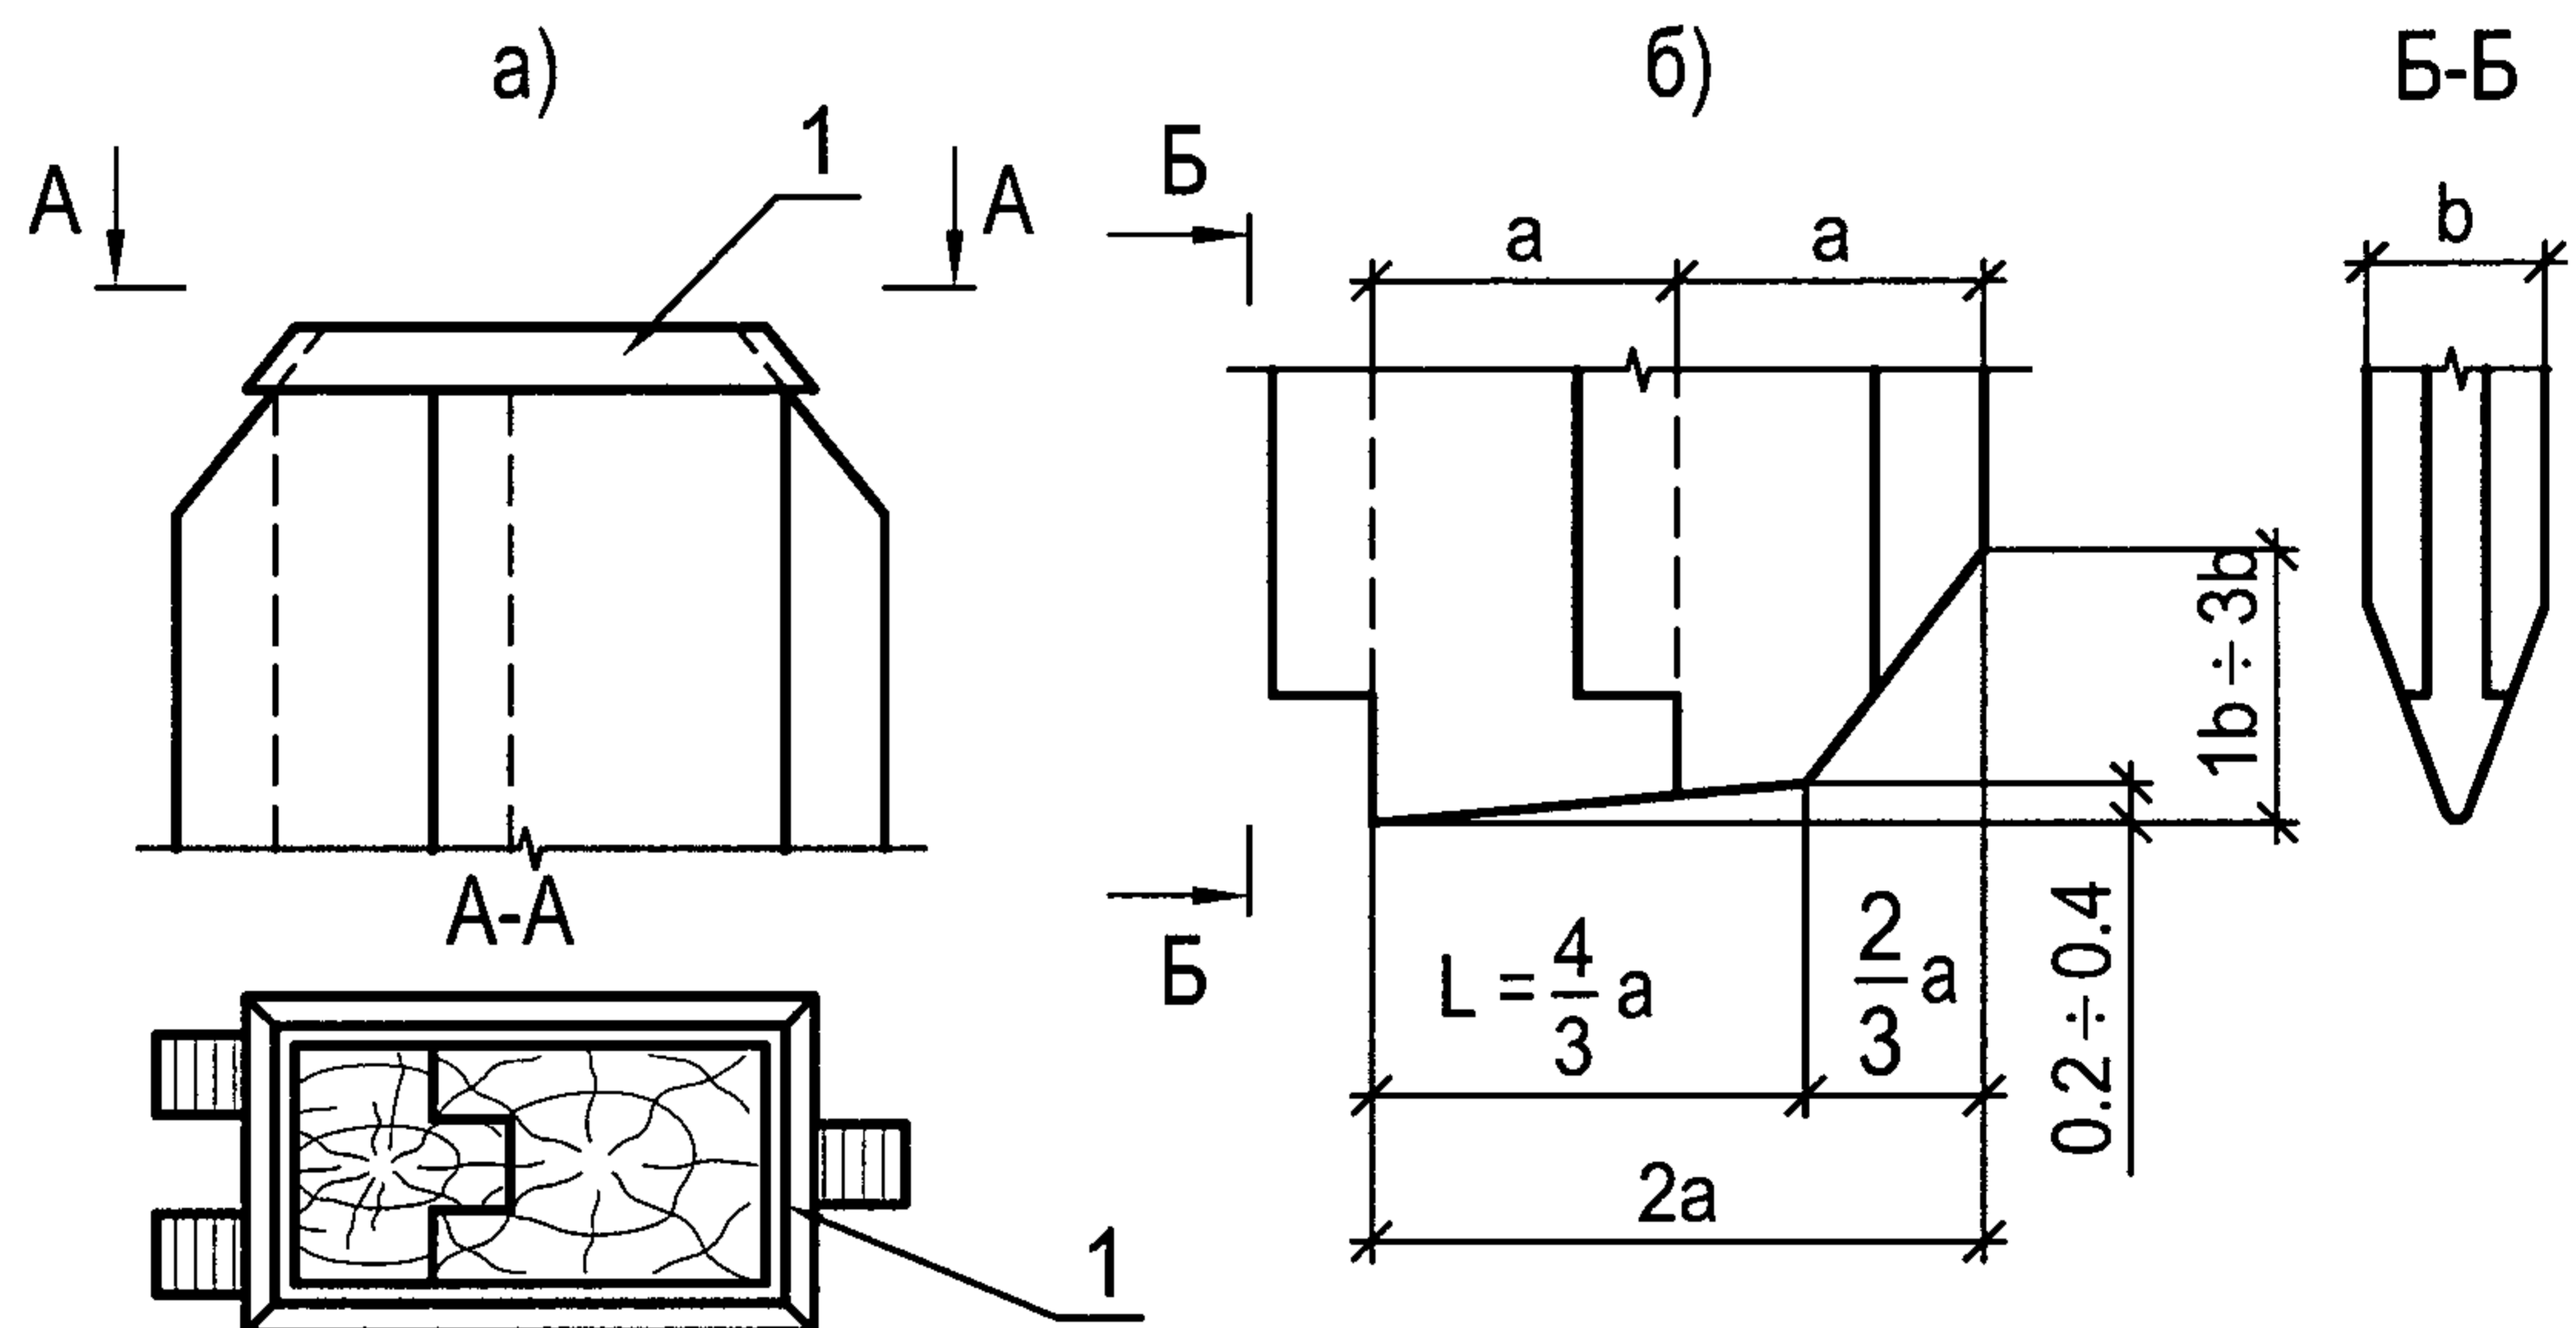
Конструкция деревянных шпунтовых свай
